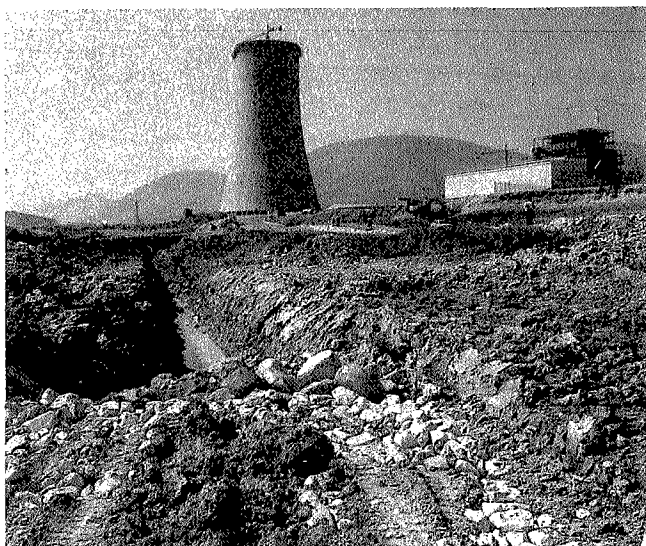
Ejecución del drenaje situado bajo el tapiz.
